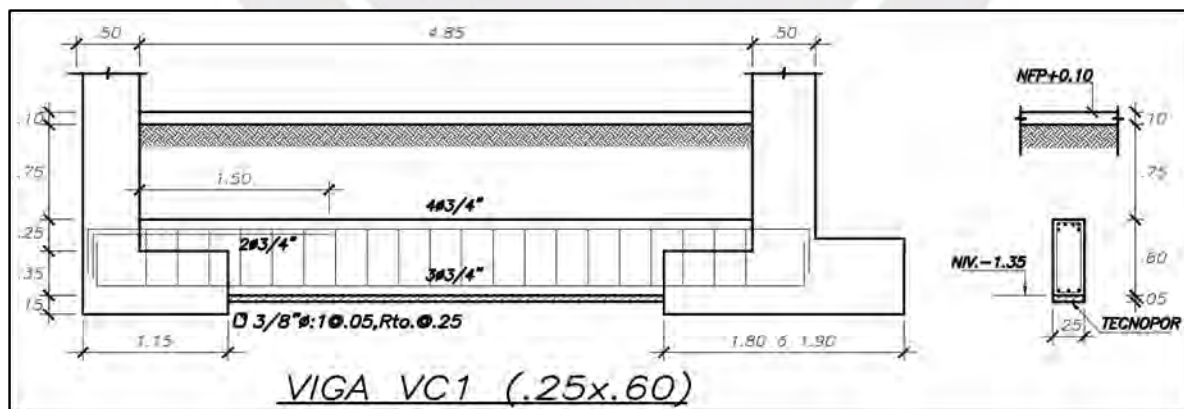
Esquema de armado final del acero de la viga de cimentación VC1
